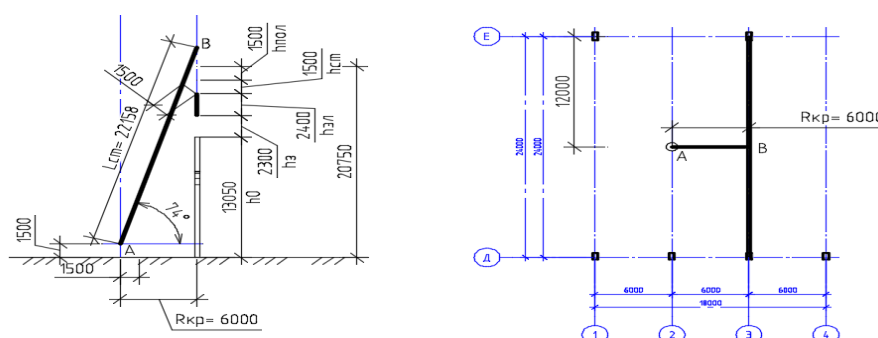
Схема выбора стрелового крана для монтажа стропильной фермы
